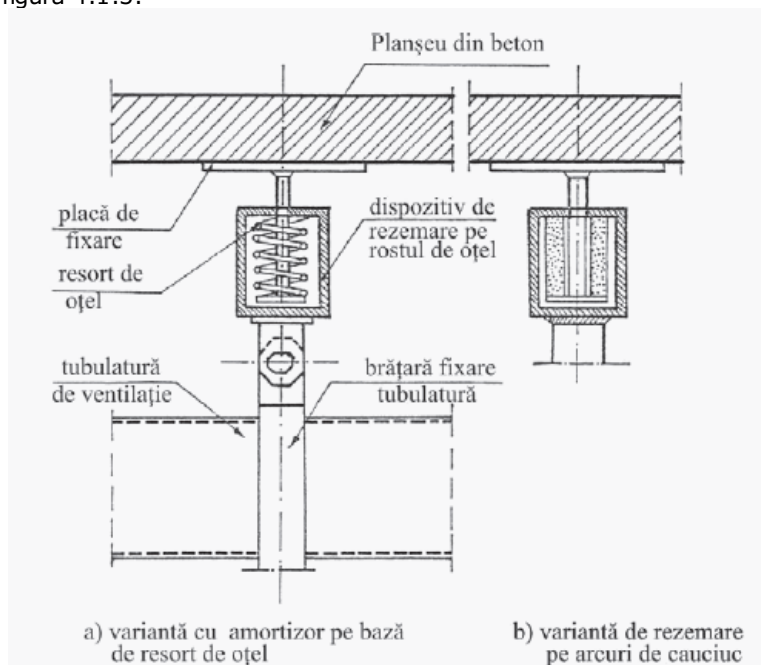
Dispozitive de fixare elastică de plafon a canalelor de ventilare
